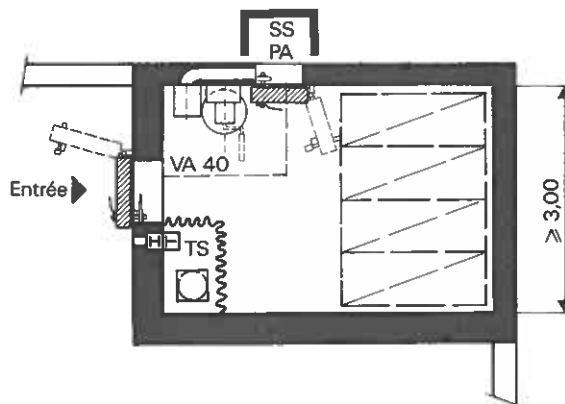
Configuration d'un abri de 12 places protégées (surface ≥ 13 m²)
